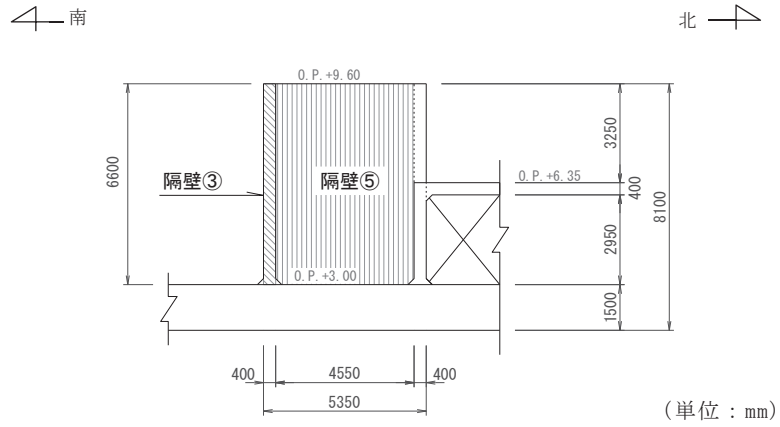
(5) 補機ポンプエリア断面図 (⑤—⑤断面)
